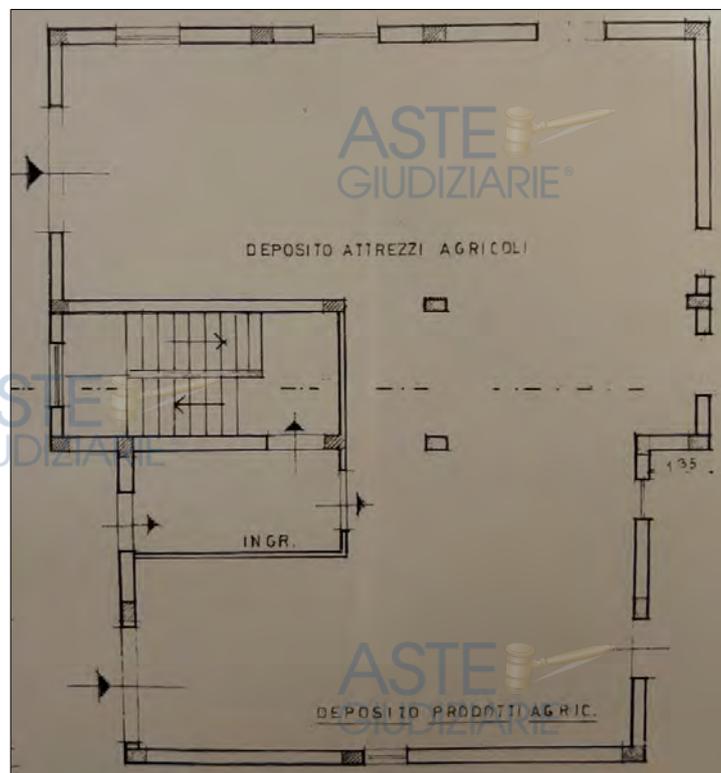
Pianta piano terra della variante n. 77 del 24/12/1996.
